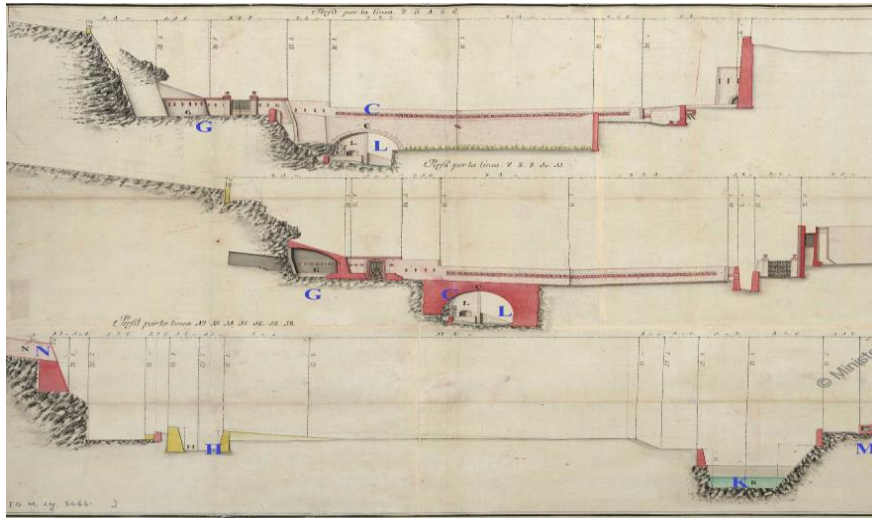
Plano de los perfiles y elevaciones de la puerta de Tremecen
